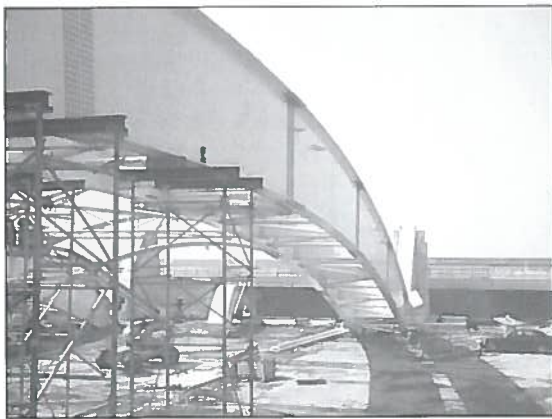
Assiemaggio di una trave principale in cantiere prima del varo sugli appoggi fissi
